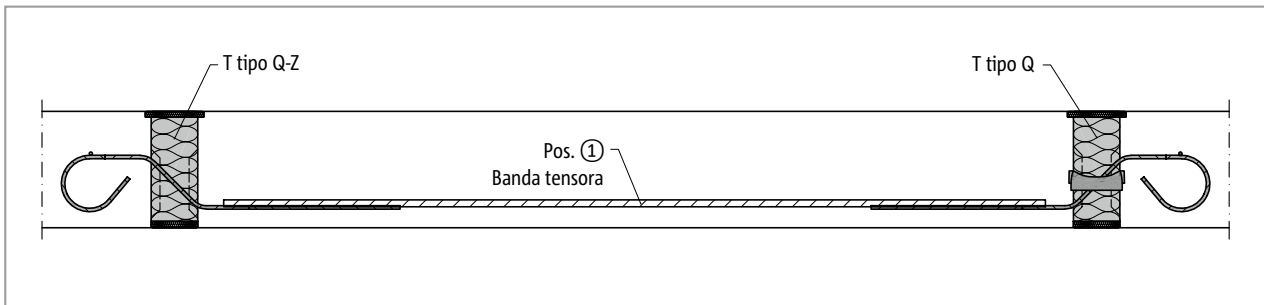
Schöck Isokorb® T tipo Q-Z-V1 hasta Q-Z-V5, Q-V1 hasta Q-V5: Sección A-A; losa de hormigón armado tensada sobre un eje
